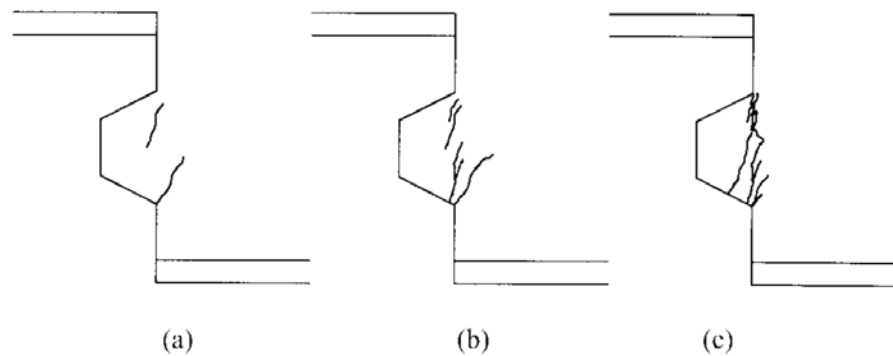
Evolución de las grietas para junta seca con una llave [20]
